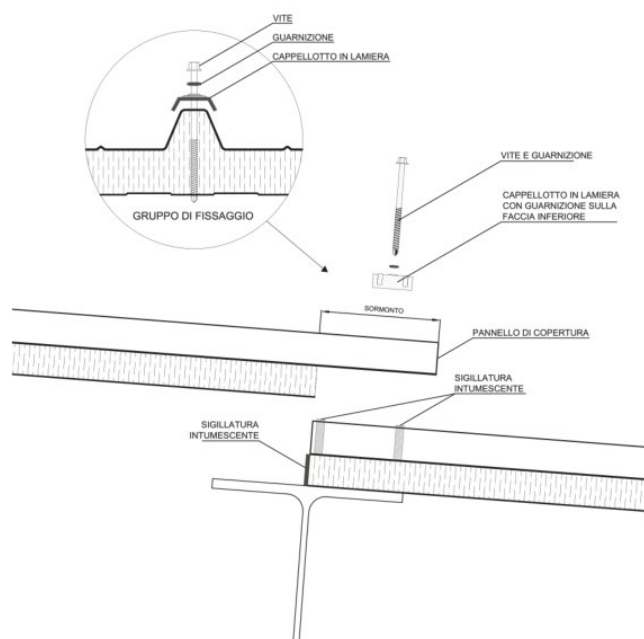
Dettaglio tipologico fissaggio dei pannelli sandwich
